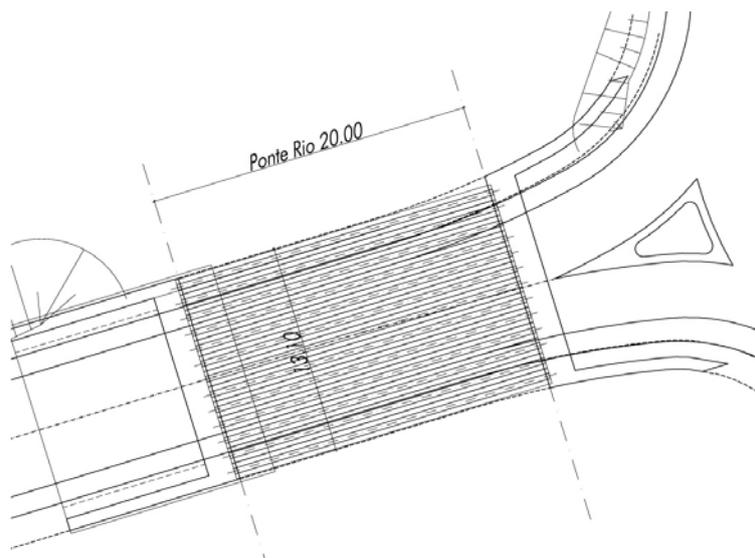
Pianta del Ponte Ries (ns. elaborazione da tavola T01VI03STRDI01_A_Pianta impalcato, sezione longitudinale e dettagli del progetto definitivo).
